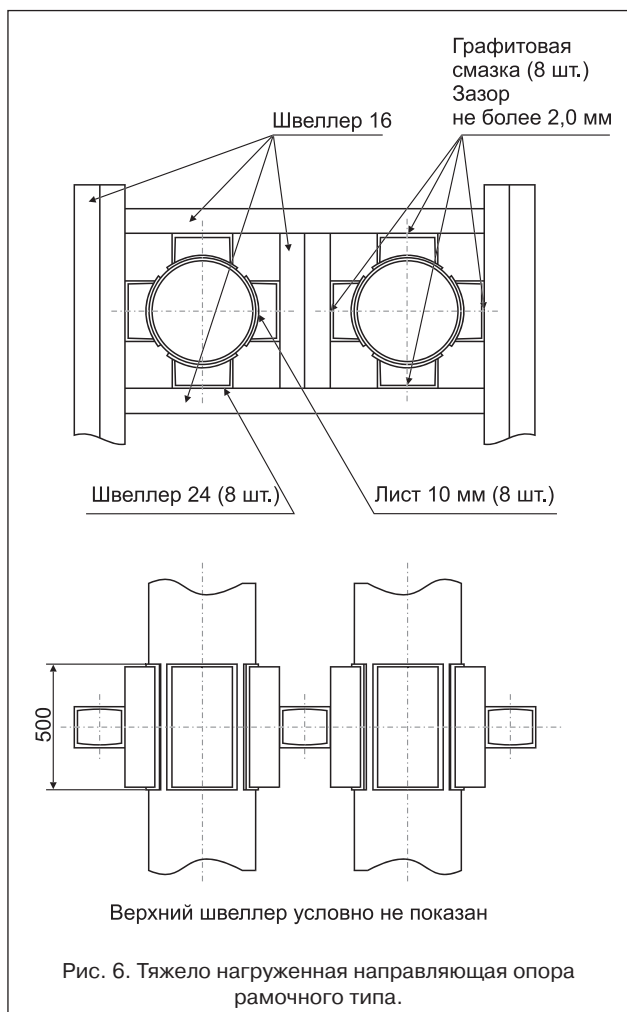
Тяжело нагруженная направляющая опора рамочного типа.
